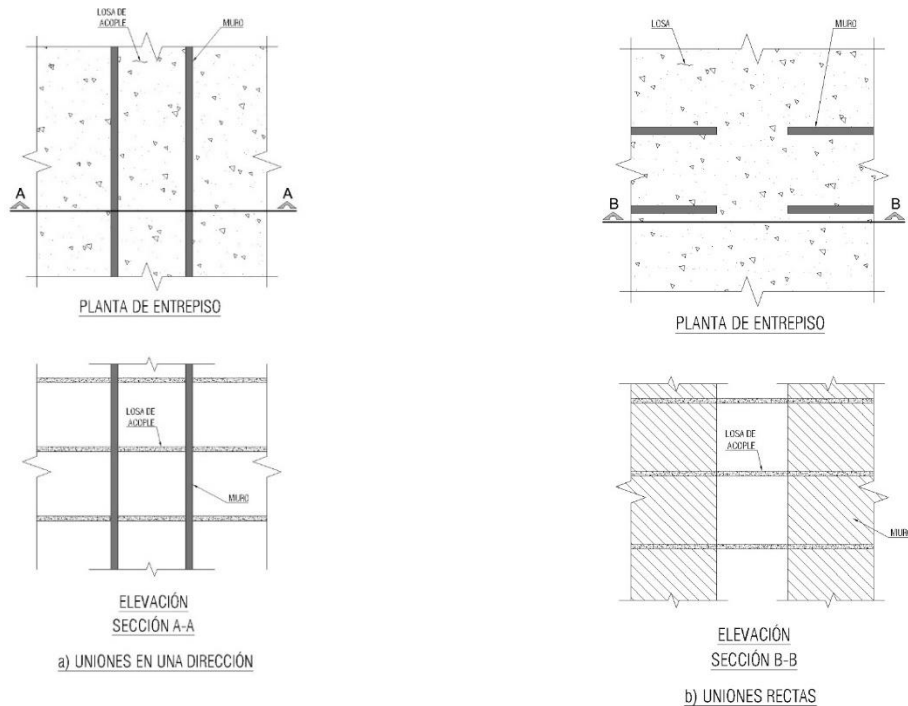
Ilustración de los tipos de unión losa-muro.
